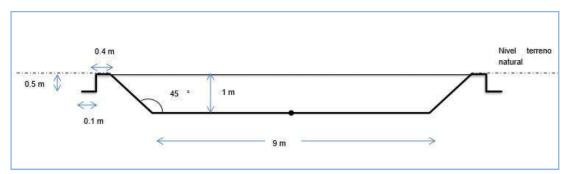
Croquis pileta lixiviado. Fuente: Proyecto UNC.
